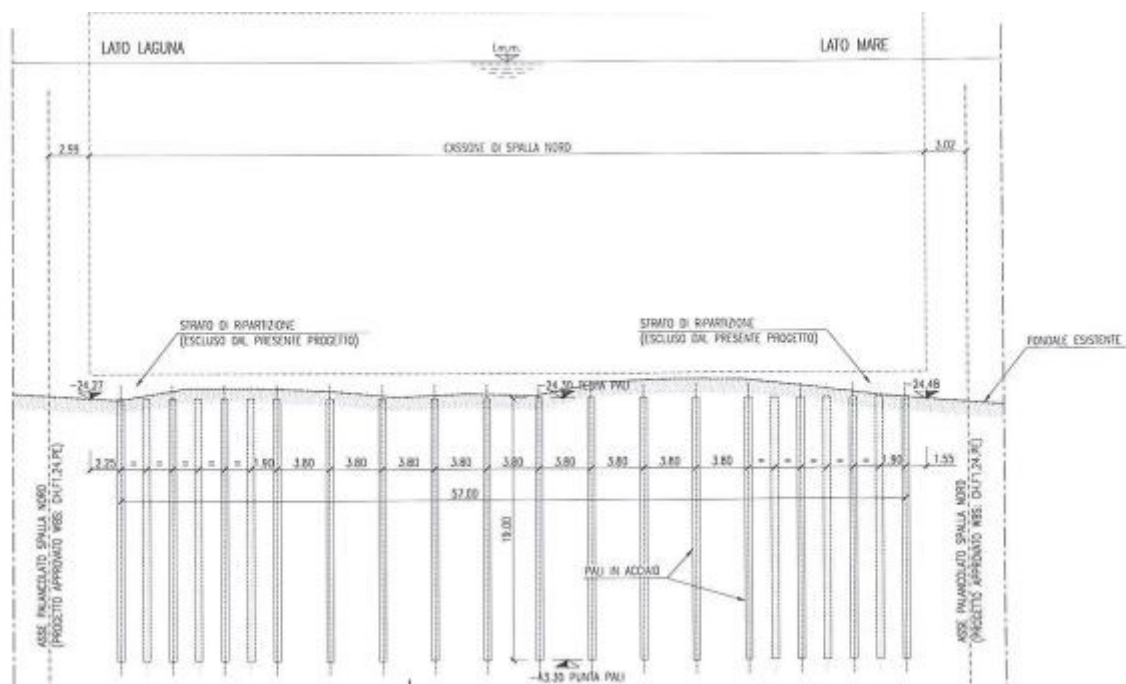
Sezione tipo cassone di spalla Nord; estratto dagli elaborati grafici AS BUILT.
